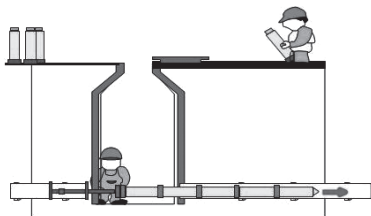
Способ ремонта трубопровода путем наращивания коротких труб
